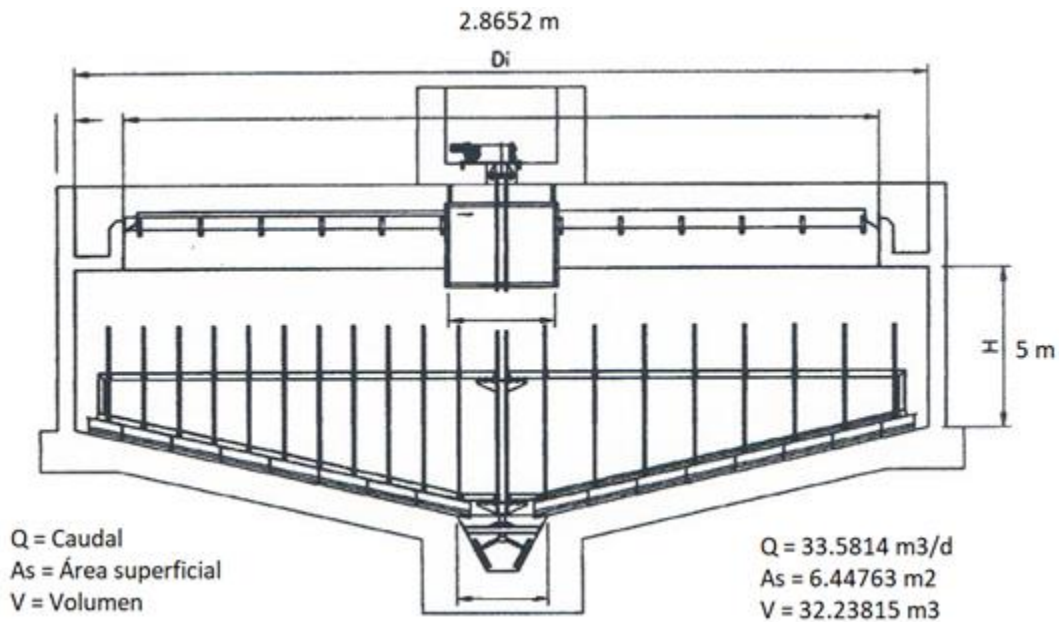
Plano del espesador por gravedad de la planta de 28 L/s. (Elaboración propia).
